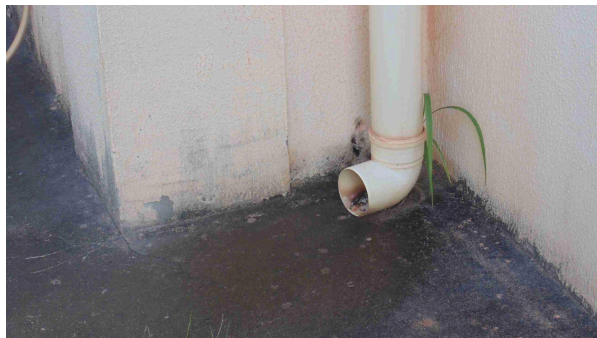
Detalhe do trecho final do condutor vertical, onde se vê que as águas pluviais não são devidamente destinadas, possibilitando o acúmulo de água parada
